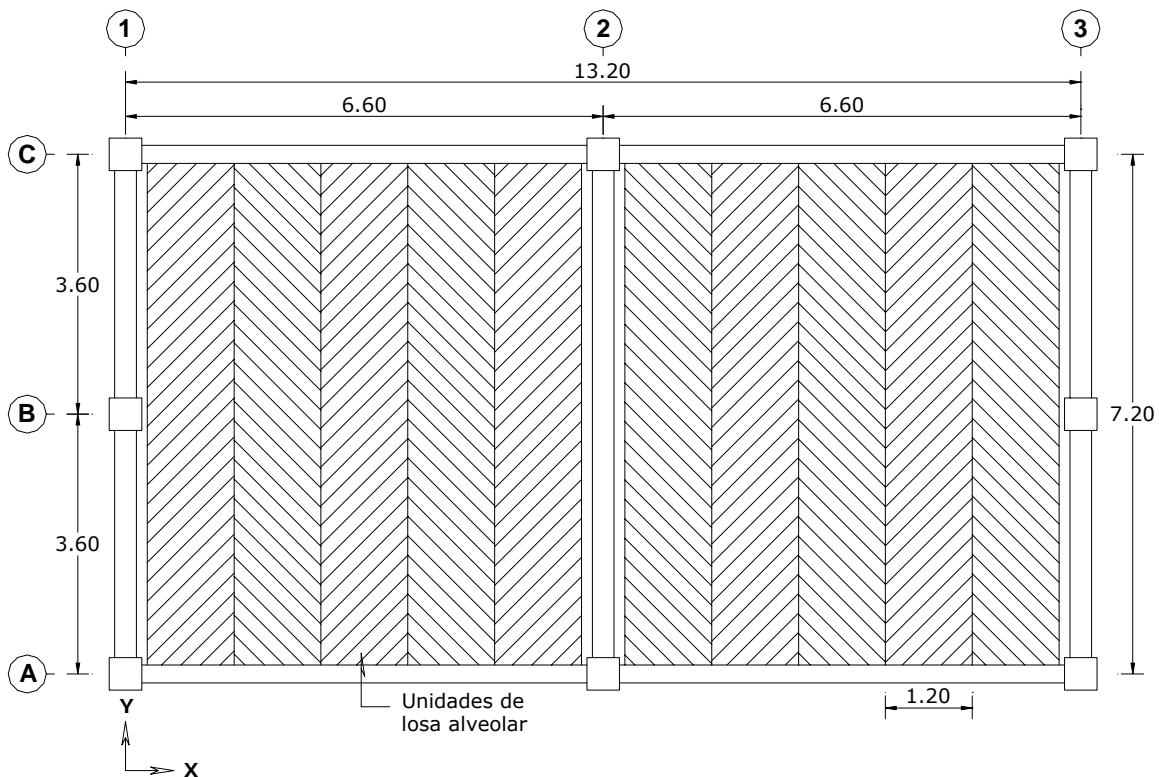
Planta del edificio prototipo (dimensiones en metros)
